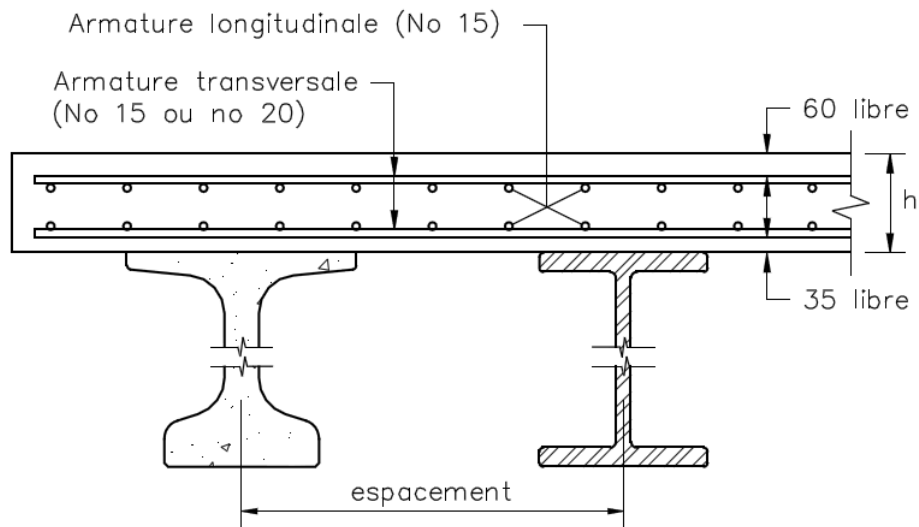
Disposition type de l'armature d'une dalle en béton armé (MTQ, 2009)
